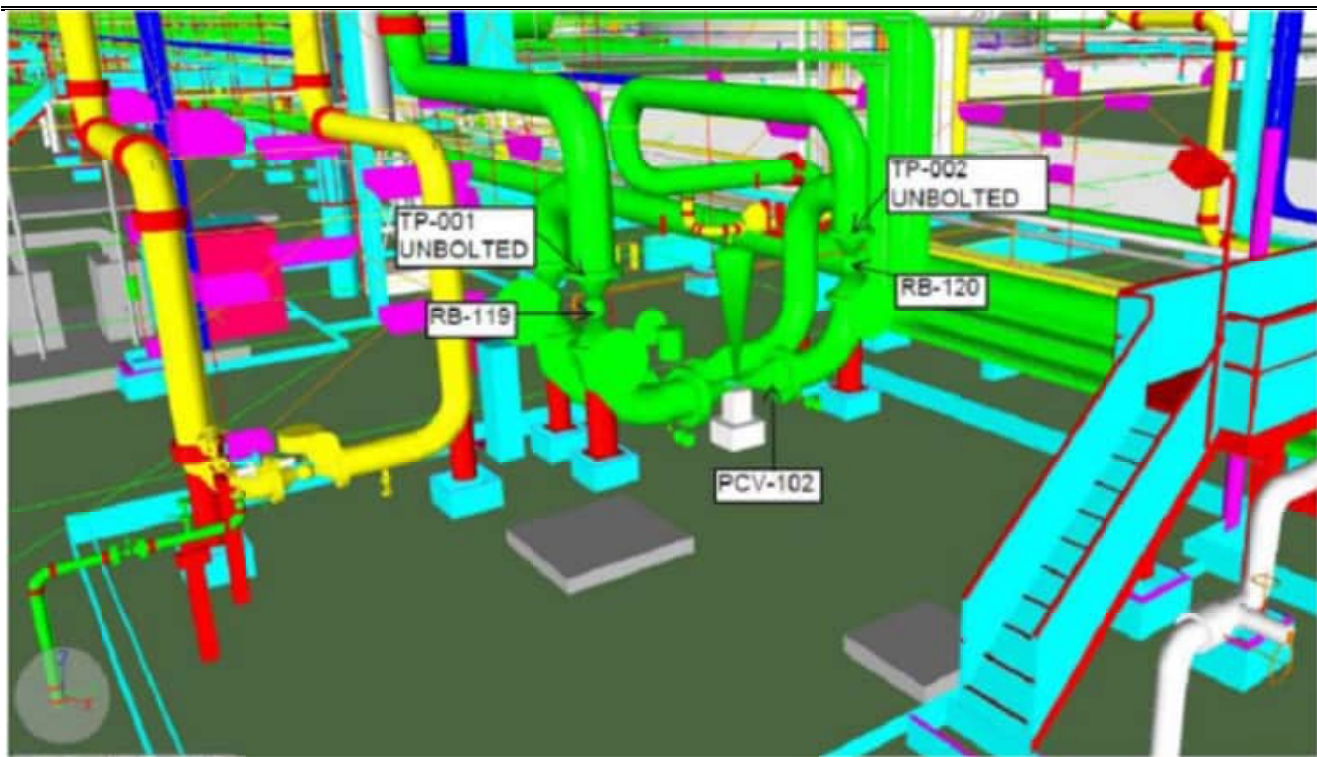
35. Схема размещения точек врезки с демонтажем необходимых участков и арматуры нефтепровода Установки 220 для дальнейшей организации монтажа блока точек подключения
